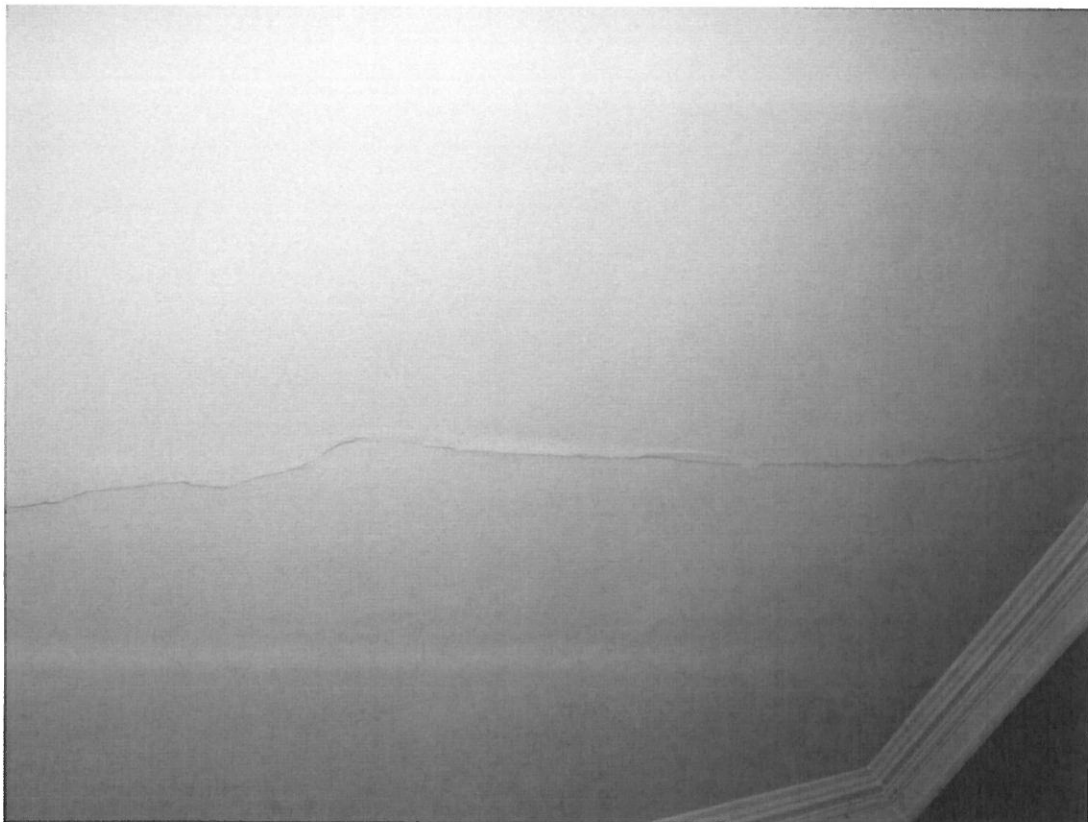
fissure de la couche de plâtre du plafond (2<sup>ème</sup> étage)
